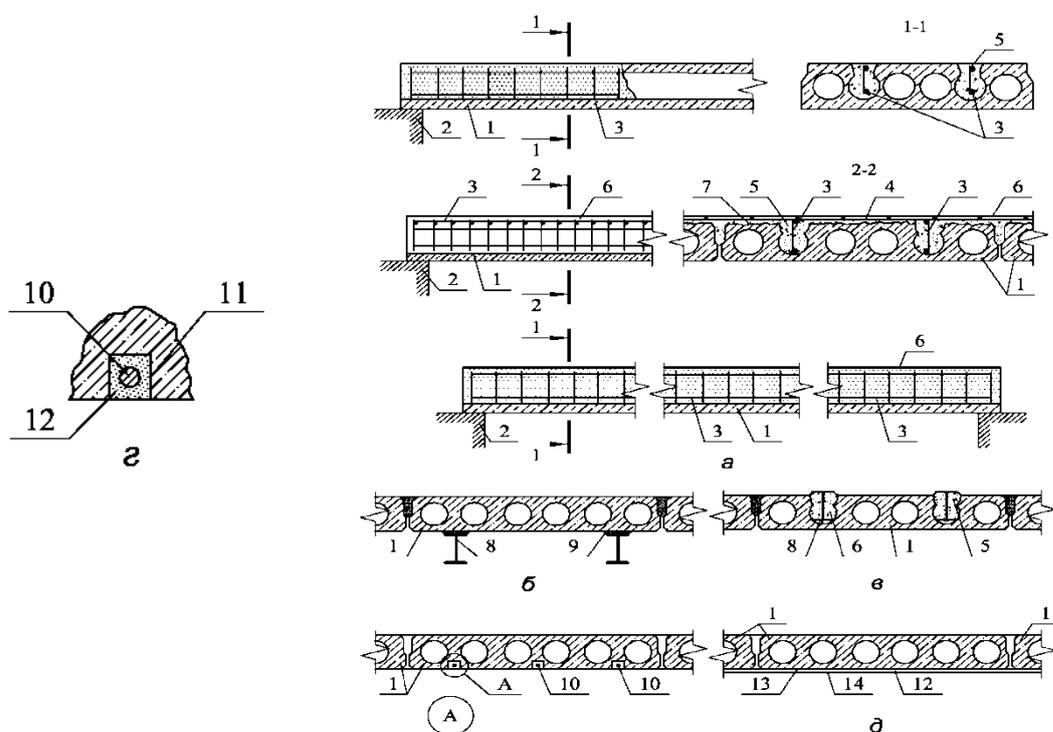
Усиление сборных многопустотных плит перекрытий: а – с установкой арматурных каркасов и бетонированием; б, в – подведением стальных разгружающих балок снизу или сверху; г – установкой дополнительной арматуры на полимеррастворе; д – наклейкой стеклоткани, ткани из углеводистого волокна или листового металла на полимеррастворе; 1 – усиливаемая плита; 2 – опора; 3 – дополнительный арматурный каркас; 4 – конструктивная арматура усиления; 5 – вырубленные полки плит в местах установки каркасов или балок; 6 – монолитный бетон усиления; 7 – поверхность сцепления монолитного бетона с плитой; 8 – стальные балки усиления; 9 – шов между плитами и разгружающими плитами; 10 – дополнительная арматура; 11 – пазы в бетоне, вырезанные фрезой; 12 – защитно-конструкционный полимерраствор; 13 – очищенная и обезжиренная поверхность плит; 14 – листовый металл, слой стеклоткани или ткани из углеродистого волокна
